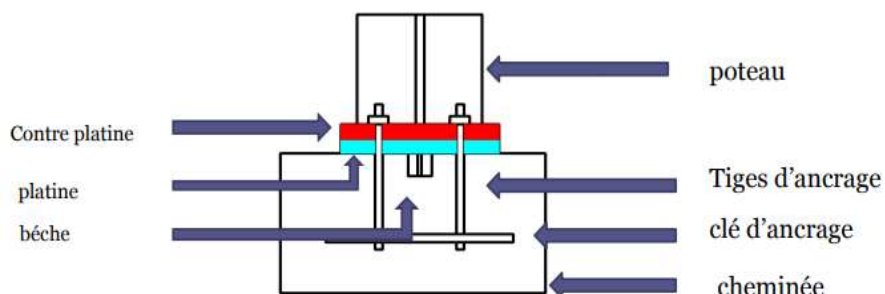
schéma d’ancrage du pied de poteau métallique dans la fondation.
